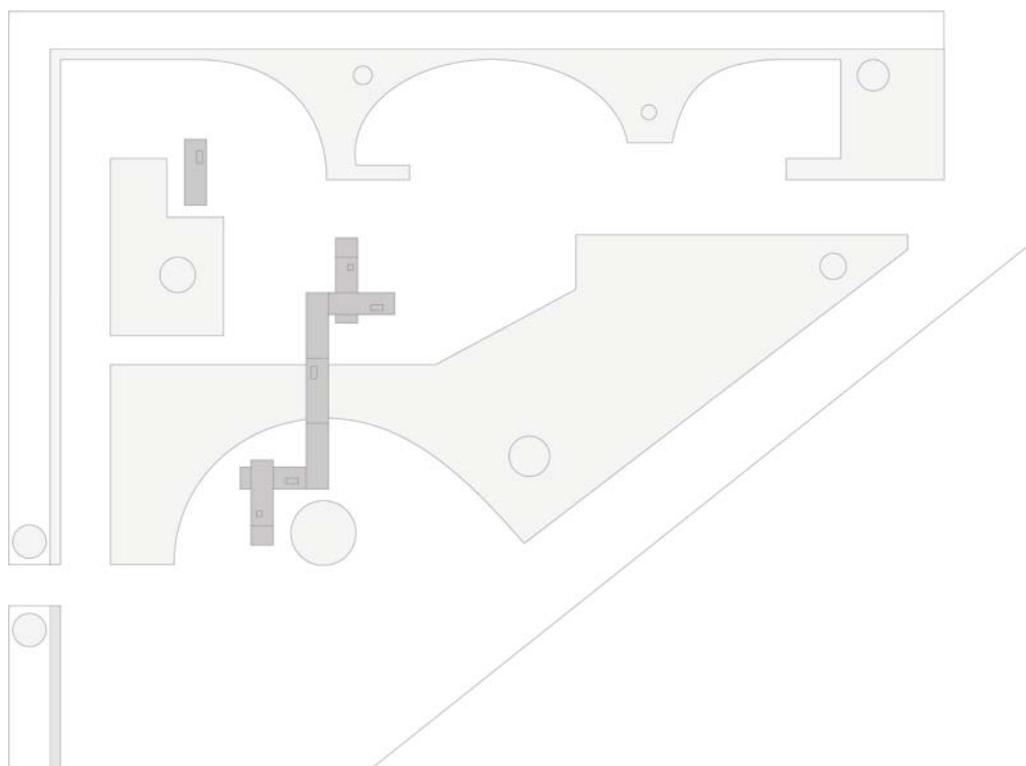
Grundriss des Schulhofes mit platziertem Entwurf
